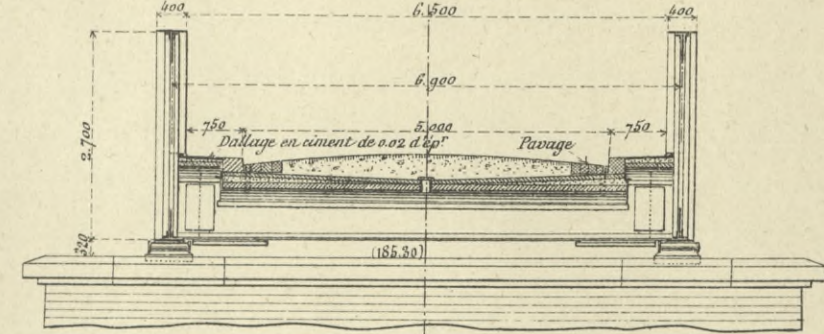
Coupe longitudinale suivant l'axe de la chaussée
